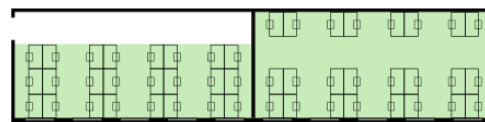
Det relevante gulvareal går fra facaden og vinkelret ind til bagkant af bagerste arbejdsplads.
